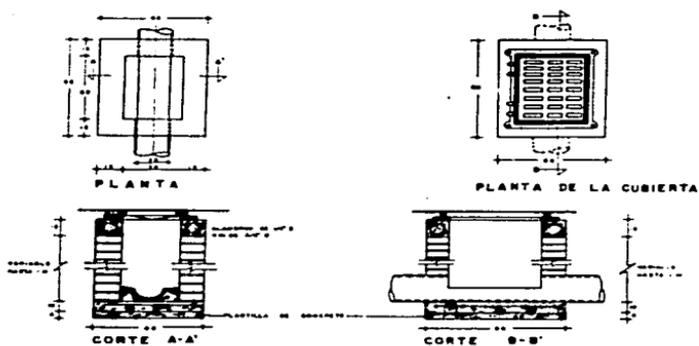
Detalle de registro tipo y coladera pluvial de piso
